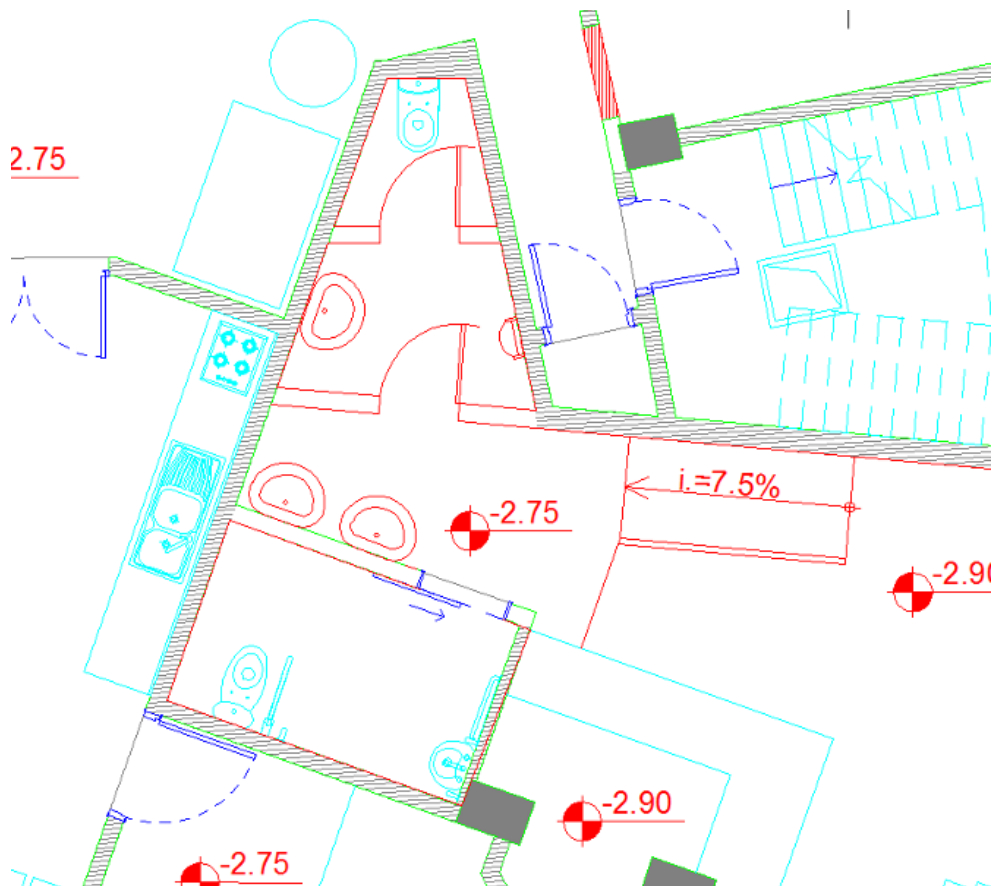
Planta do piso -1 na zona I.S. sociais da sala de refeições [Atelier B2, 2019]
